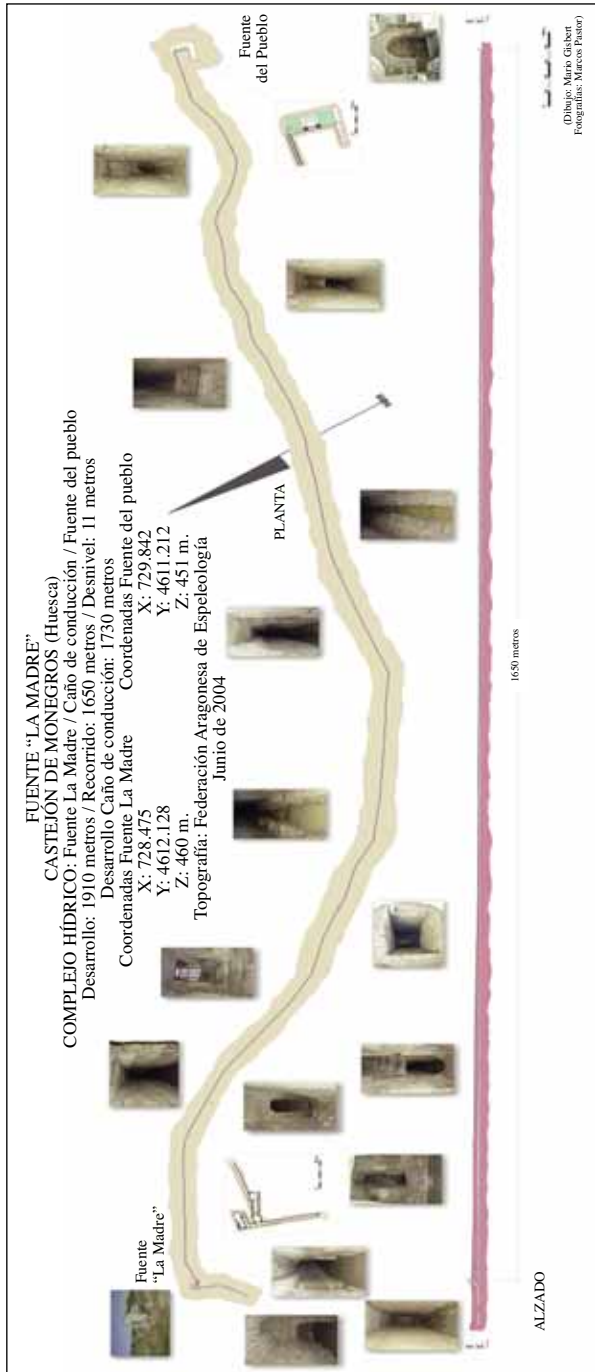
Planta de La Madre y caño de Castejón de Monegros.
